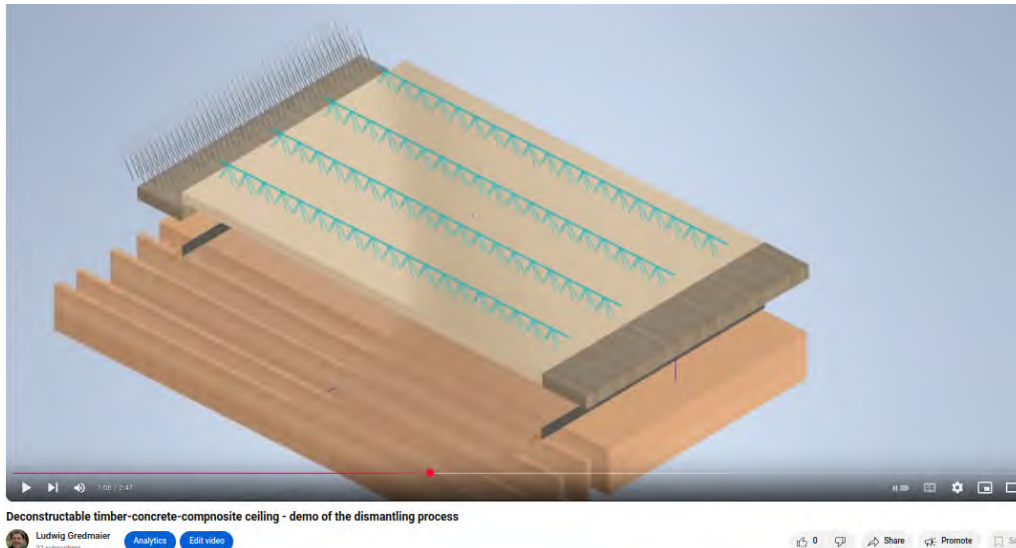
Einfache Animation des Rückbaus der Holz-Beton-Verbunddecke auf <https://youtu.be/us5E5M98Goo> (zuletzt aufgerufen Mai 2025).
